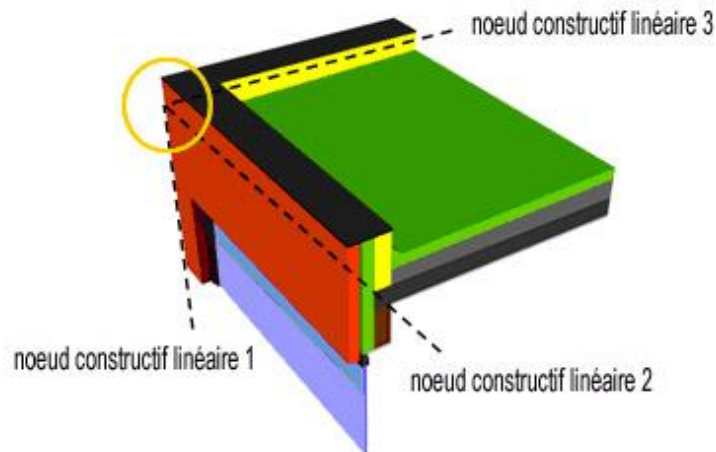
L'intersection de trois nœuds constructifs linéaires ne doit pas être prise en compte comme un nœud constructif ponctuel.
